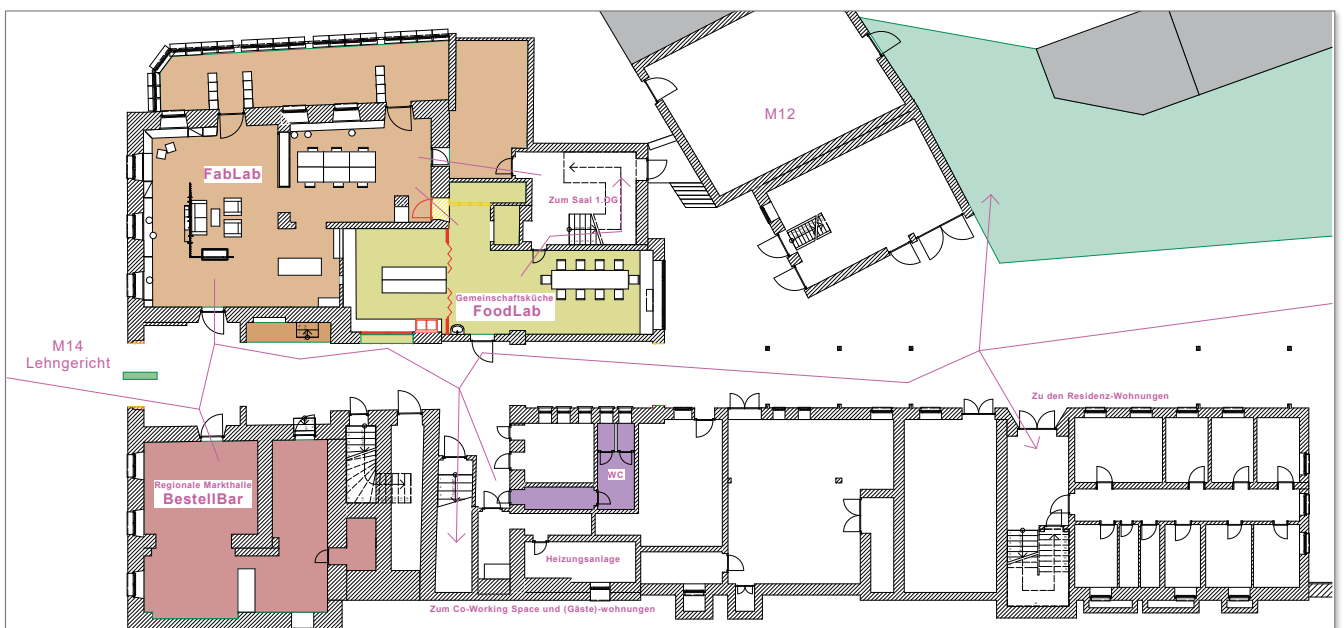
Erdgeschossgrundriss - Nutzungskonzept Altes Lehngericht (M14), Darstellung Esther Gerstenberg
